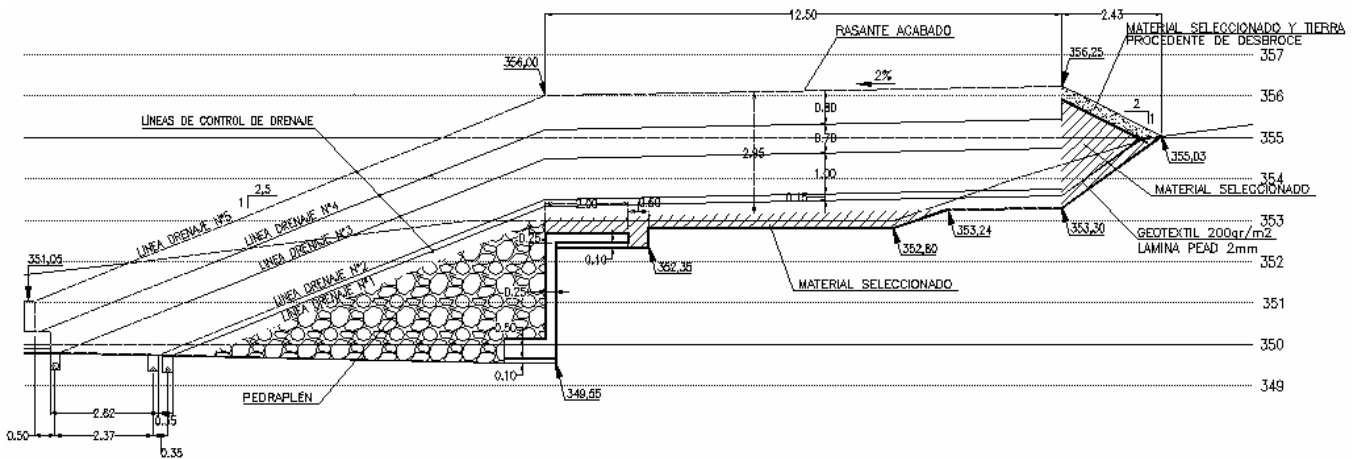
Detalle de la sección de la cobertura de ensayo II, donde se pueden observar las líneas de drenaje
